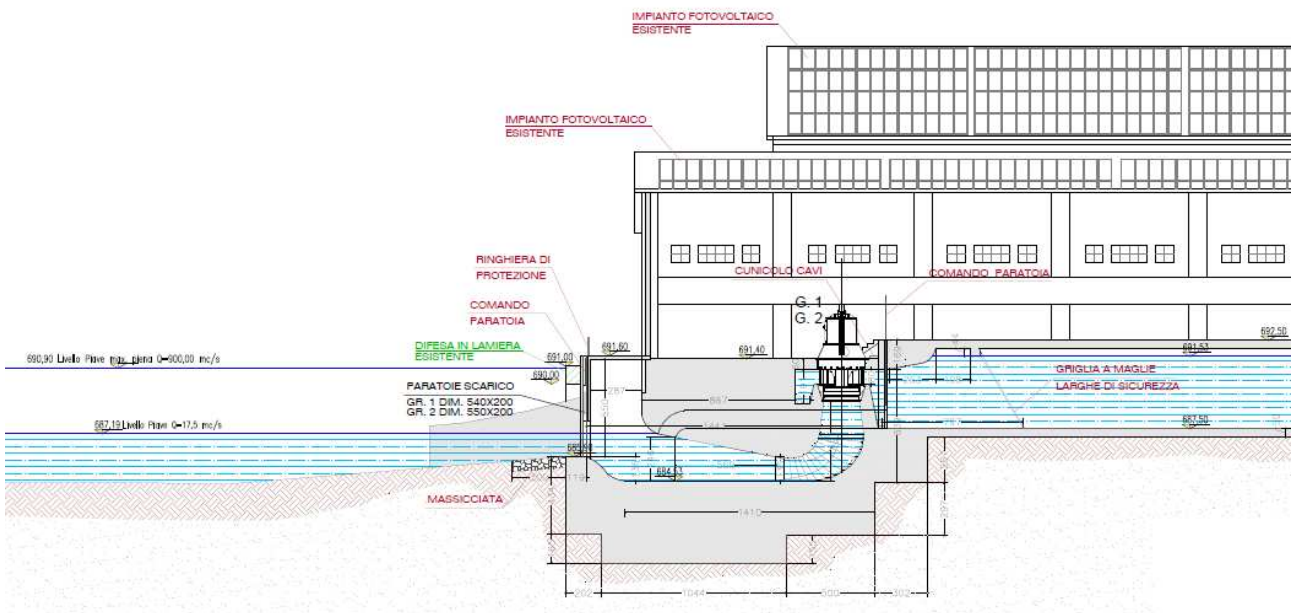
Estratto Tav. 10 - Sezione edificio centrale.
